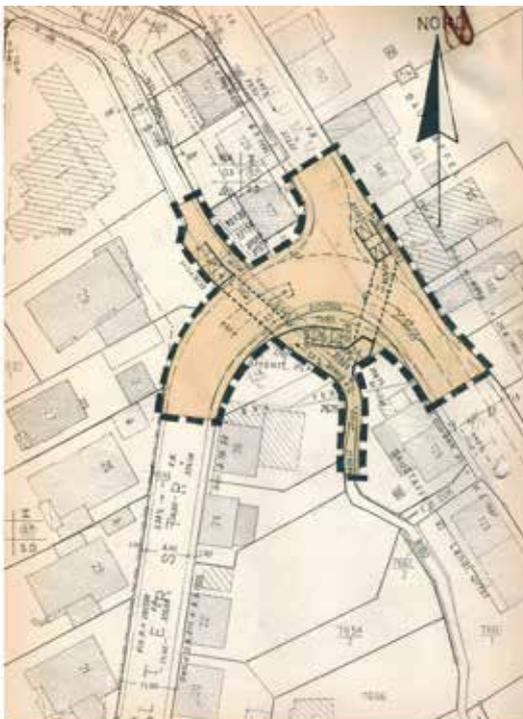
Bebauungsplan 1974 Unterführung (Plan Bürgerausschuss RSKN)
